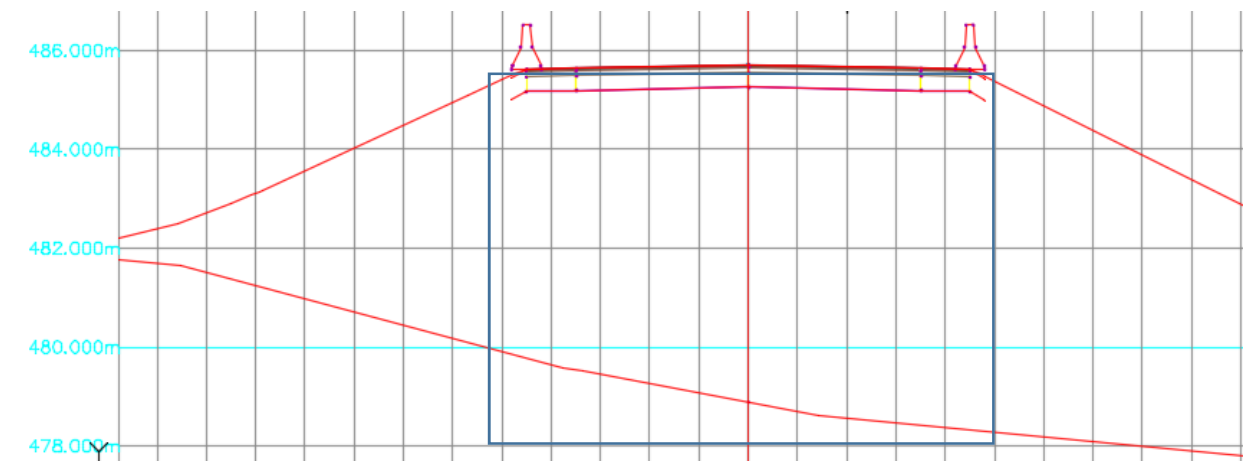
Cálculo de la distancia de soterramiento, estribo 1
